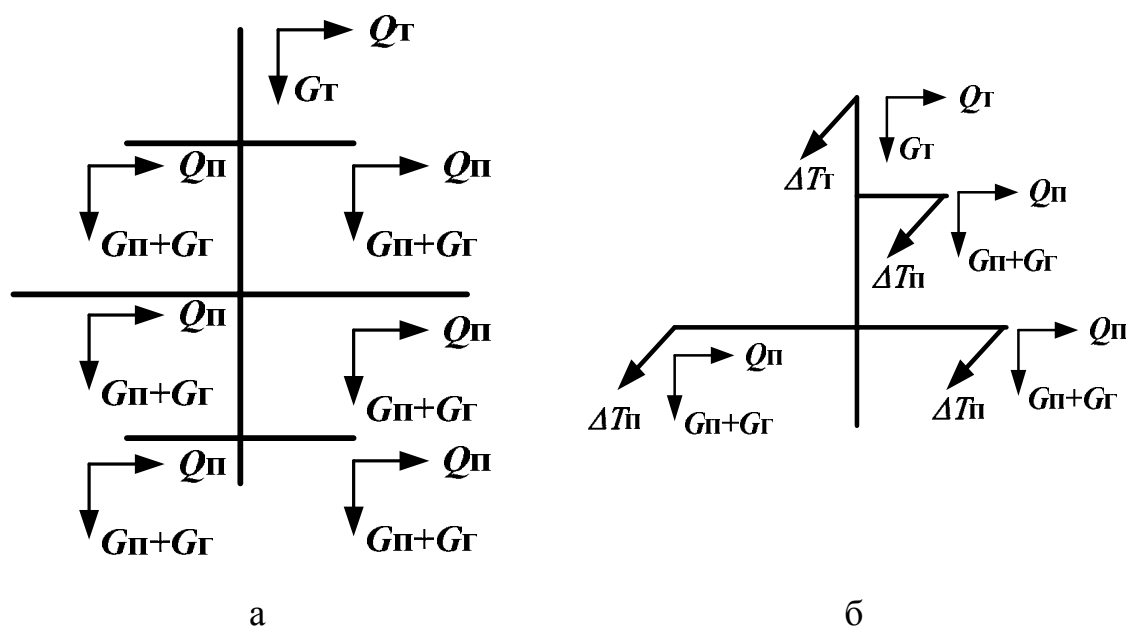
Схемы нагрузок на опору в нормальном режиме работы воздушной линии: а – на промежуточную двухцепную; б – на анкерную
